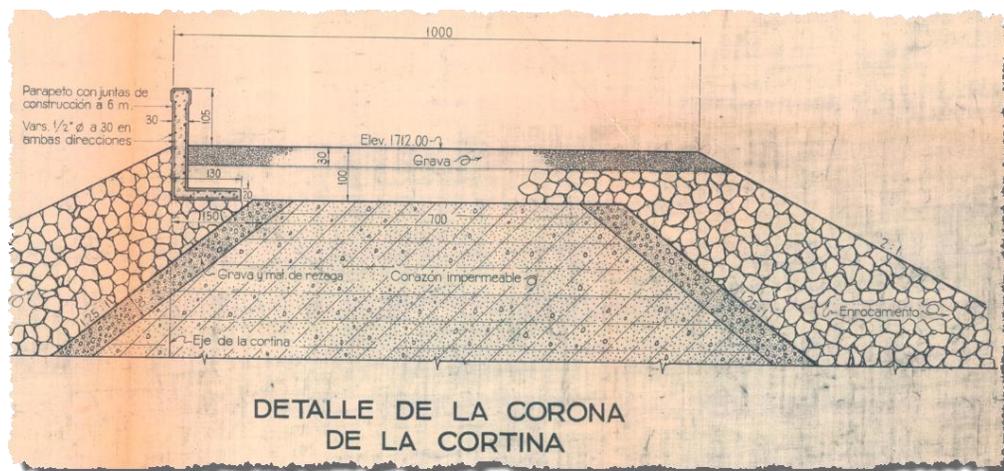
Detalle de la corona de la Cortina de la Presa el Tintero.
